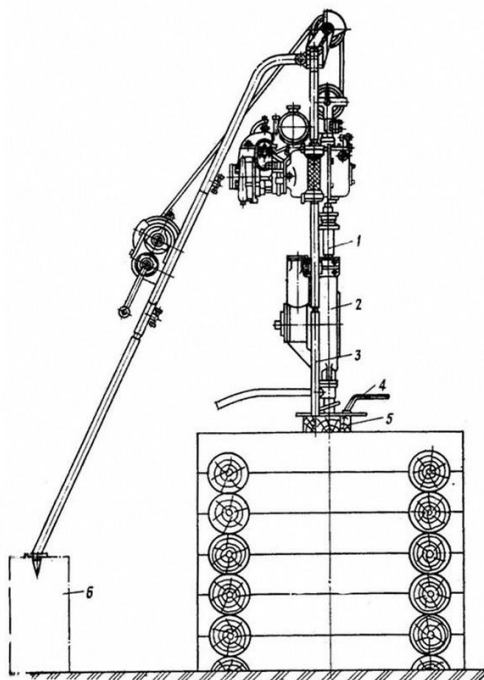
Схема установки МШК-15 на шахтному колодязі: 1 – патрон для відкачування; 2 – насосна колонка; 3 – подовжувач; 4 – підкладна рамка; 5 – поперечина; 6 – додаткова підкладка
